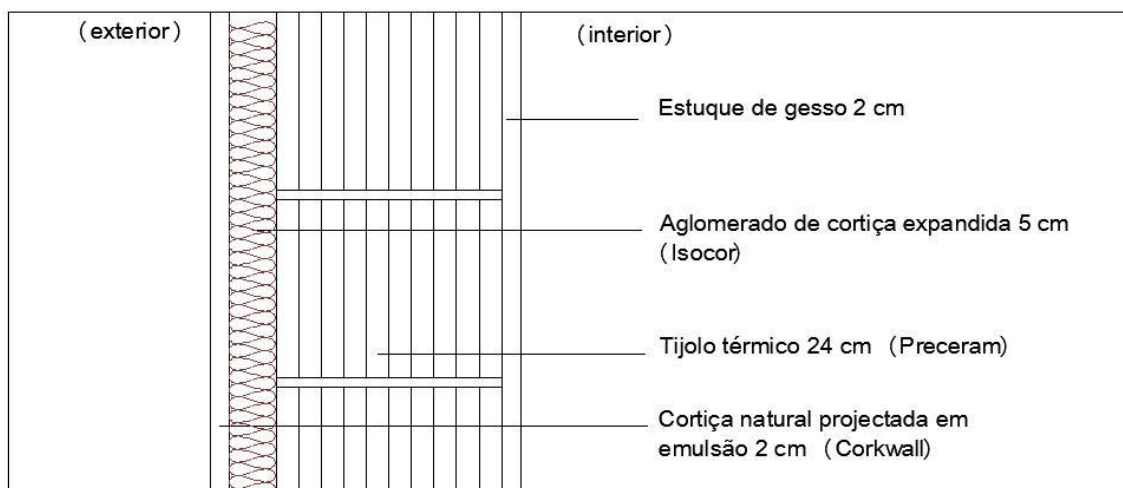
Pormenor construtivo de parede exterior proposta na solução 2
